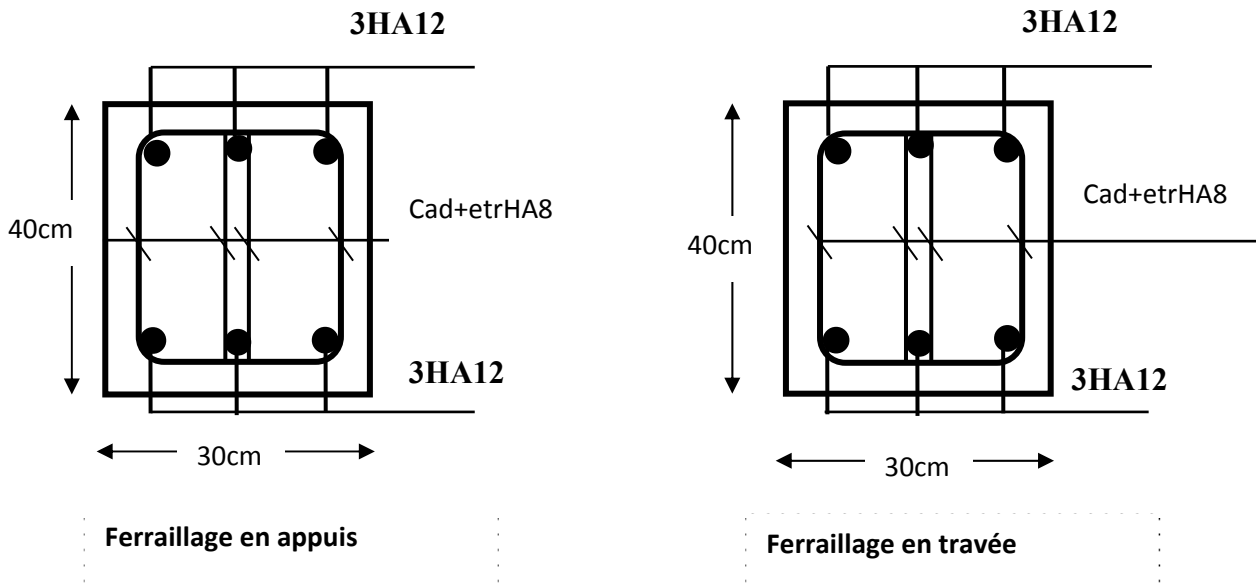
Schéma de ferrailage de la poutre palière du 2^{ème} Type d'escalier.
